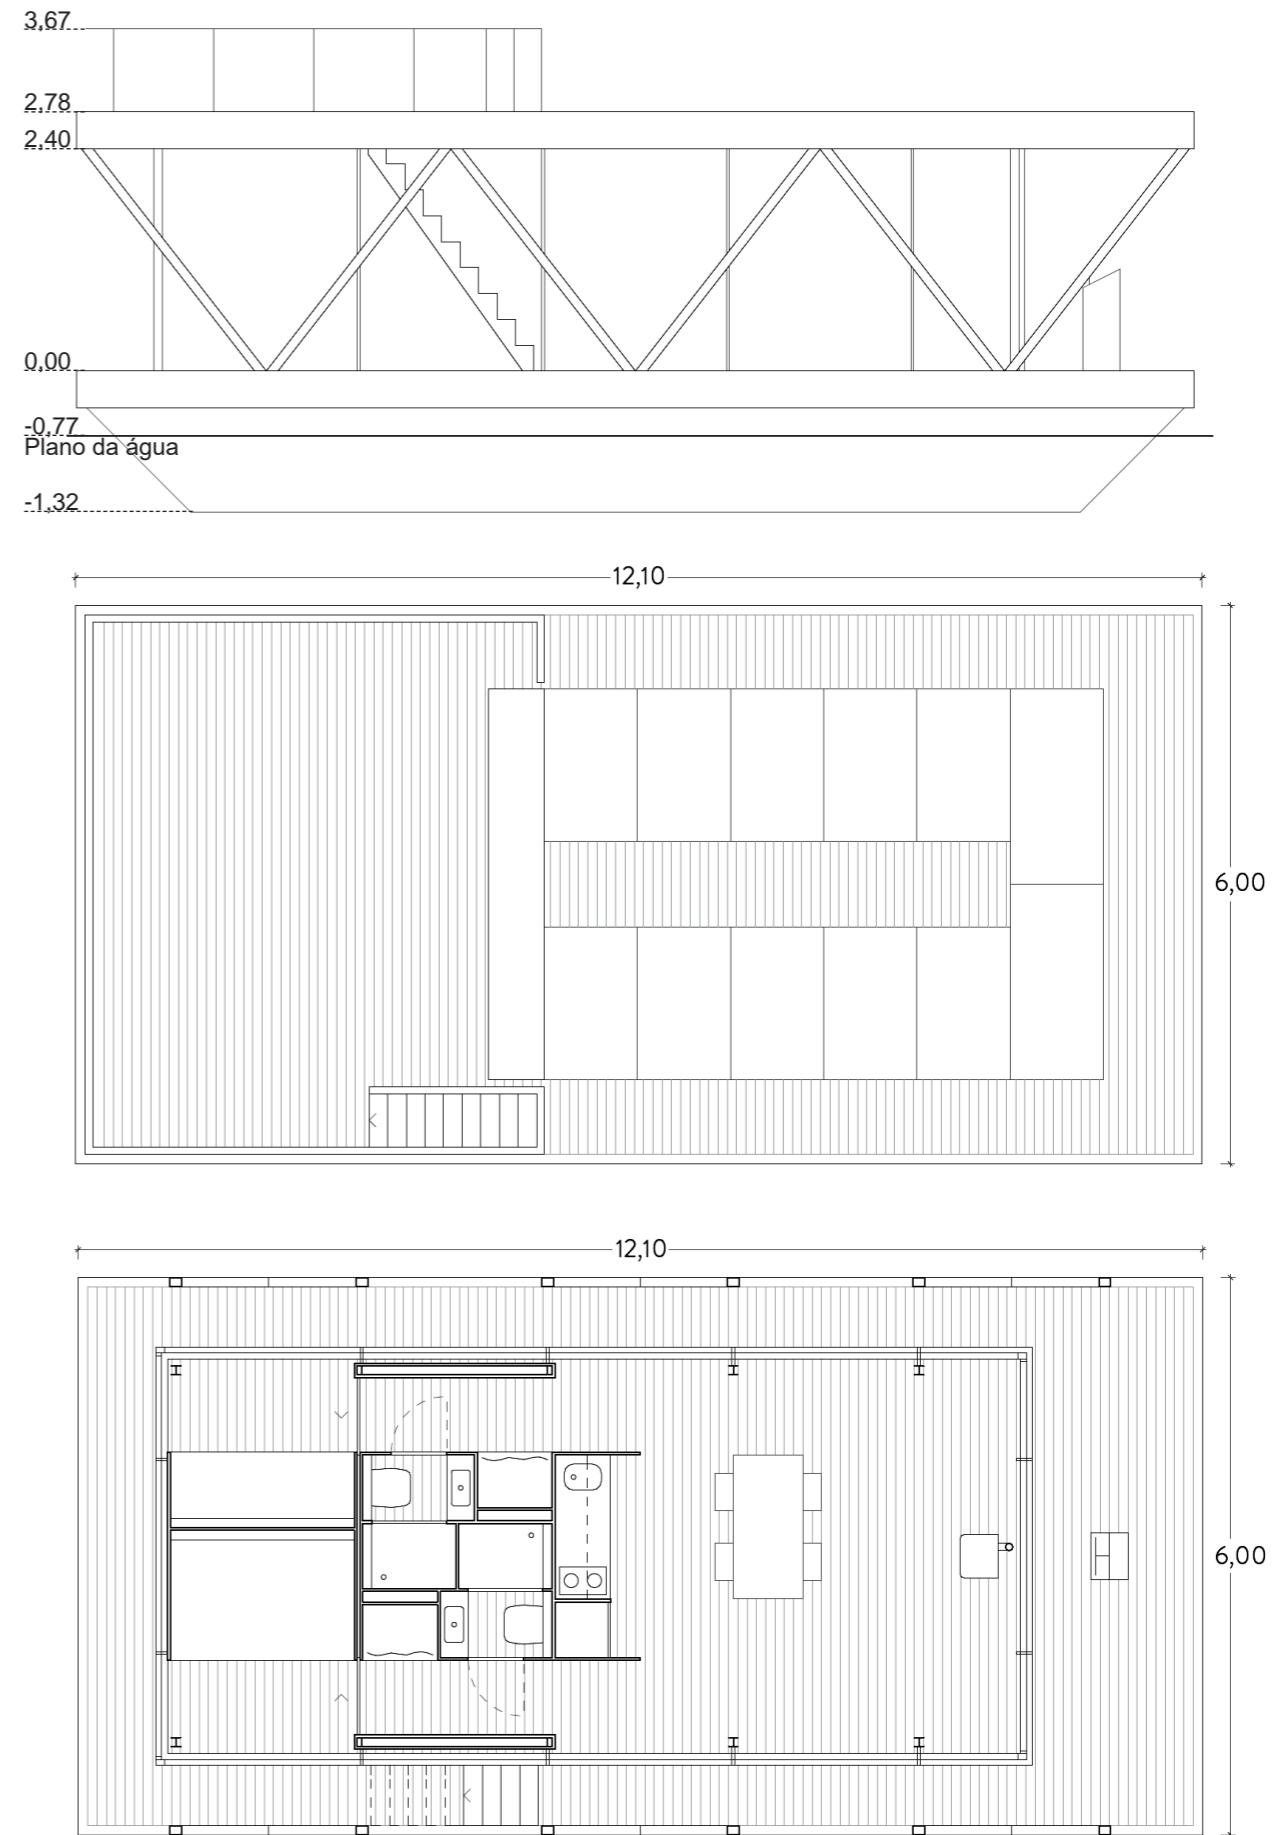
Floatwing. Vista longitudinal, planta de cobertura e planta de piso de um exemplo de organização . Fonte: <<https://www.gofriday.eu/>> Acesso em 09/03/2021.
